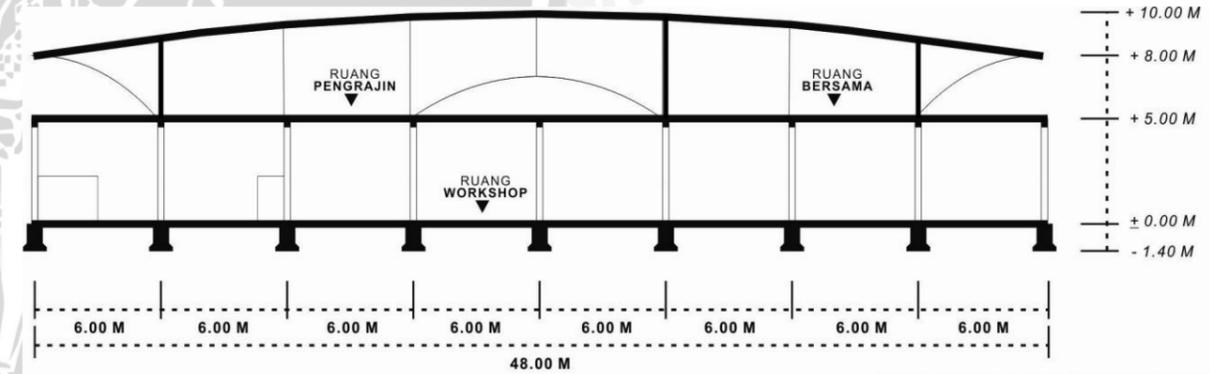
Gambar bangunan rest area, denah dan potongan.
